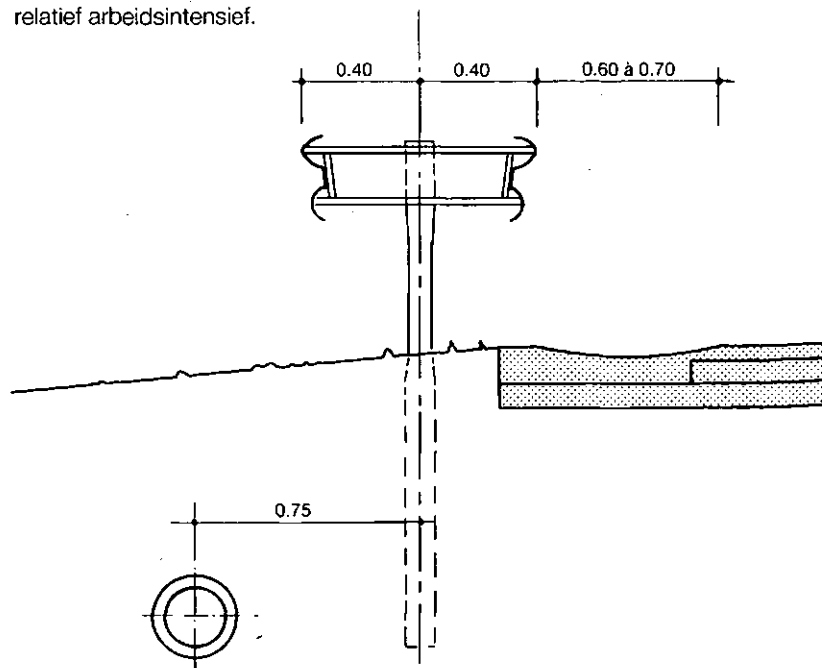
Constructie bij toepassing van zeer open asfaltbeton.
